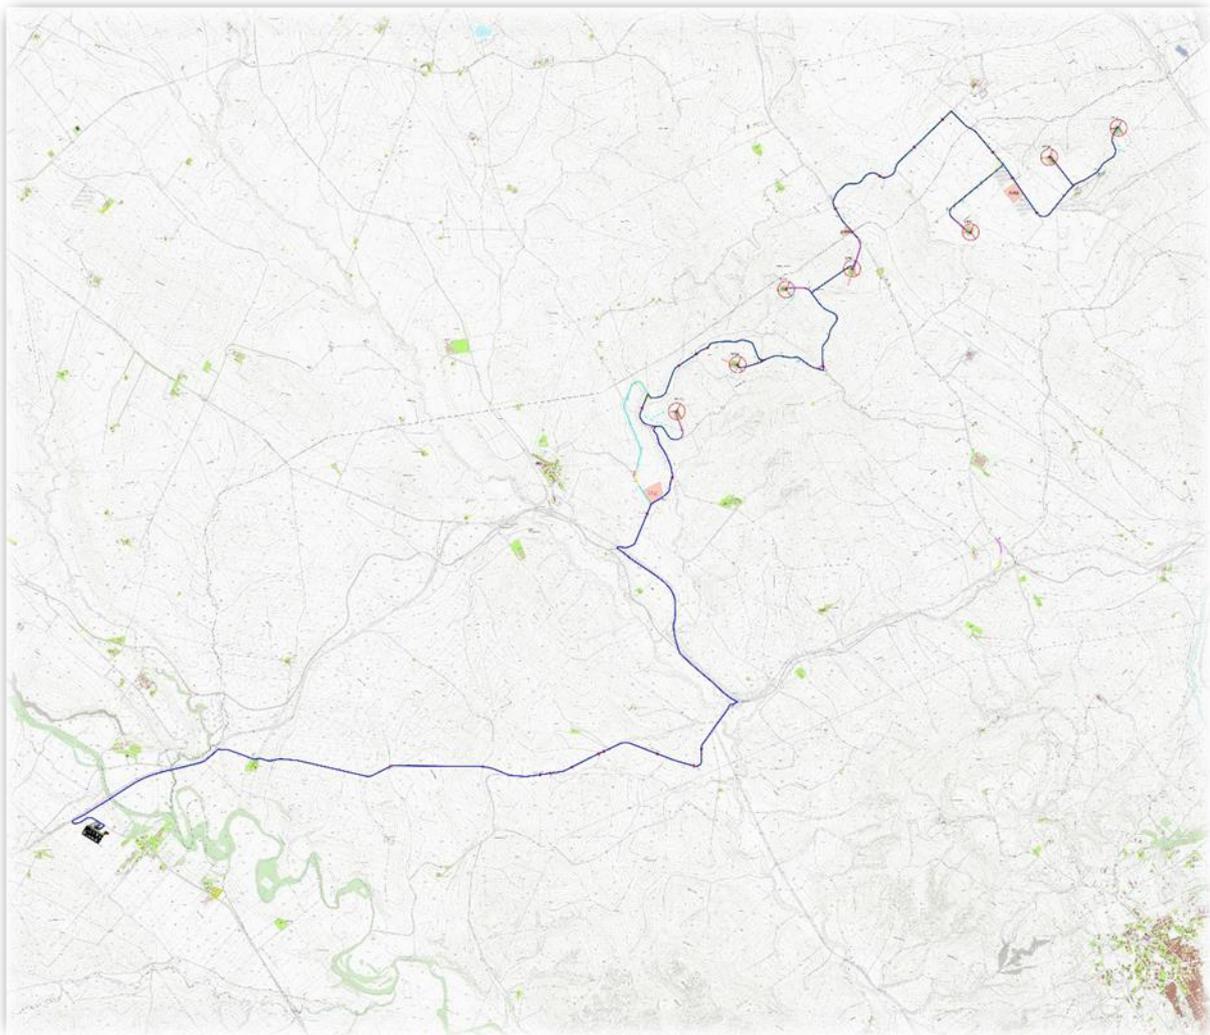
Layout dell'impianto con il tracciato dell'elettrodotto sino alla sottostazione Terna in agro di Oppido
